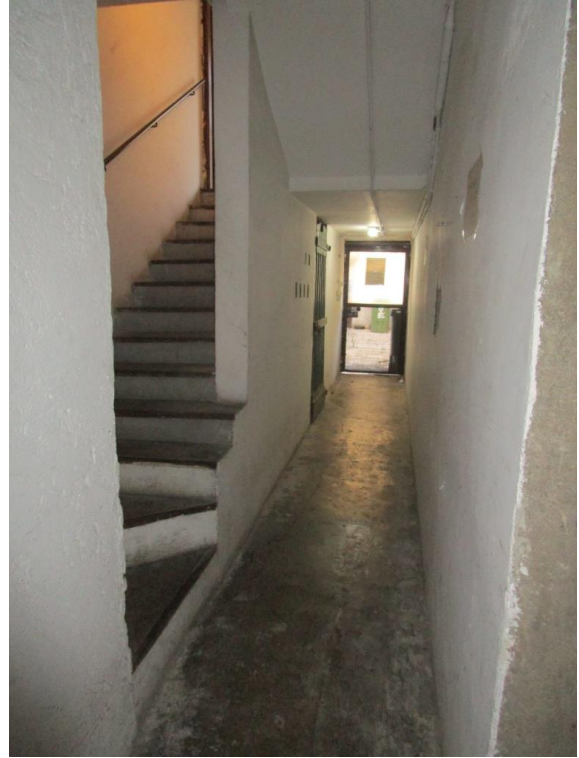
/25 – Scala e corridoio di accesso al piano cantine
